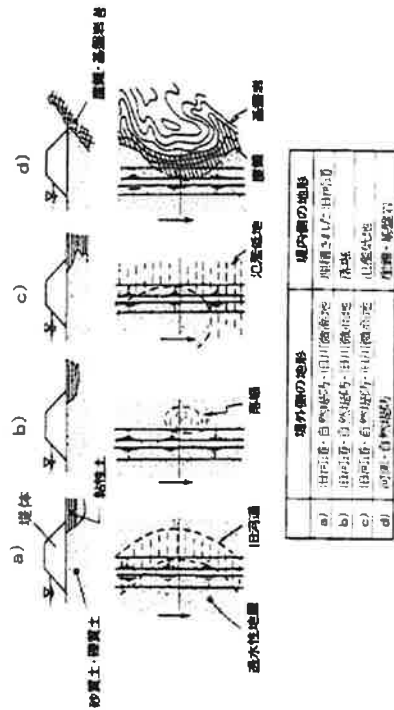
浸透が問題となる基礎地盤の土質構成
